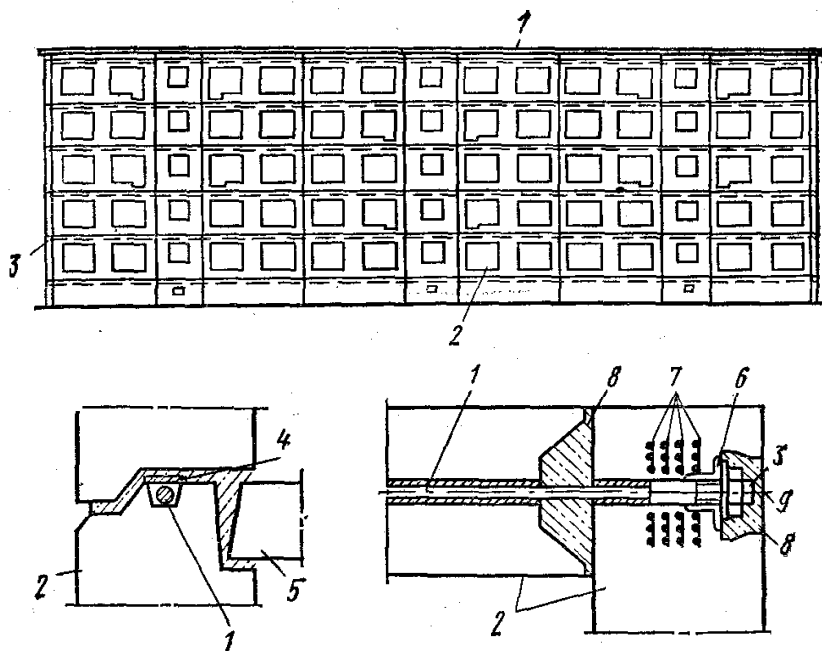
Вариант технического решения повышения жесткости панельных зданий при строительстве: а – фасад; б – горизонтальный стык панелей; в – анкеровка тросов; 1 – трос; 2 – стеновая панель; 3 – анкер; 4 – закладная деталь; 5 – перекрытие; 6 – бетон в вертикальном стыке; 7–арматурная сетка; 8 – заделка бетоном; 9 – гайка с шайбой
